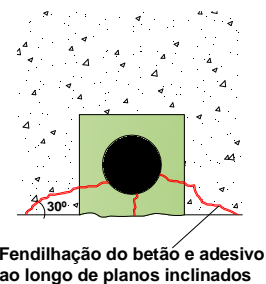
Rotura no betão e adesivo ao longo de planos inclinados [adaptado de 53]
